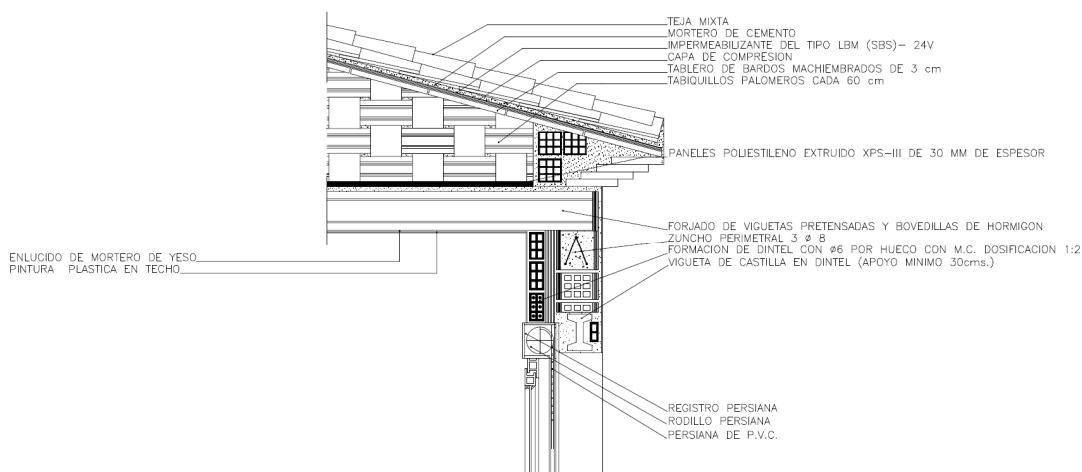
Detalle sección constructiva de la vivienda.
